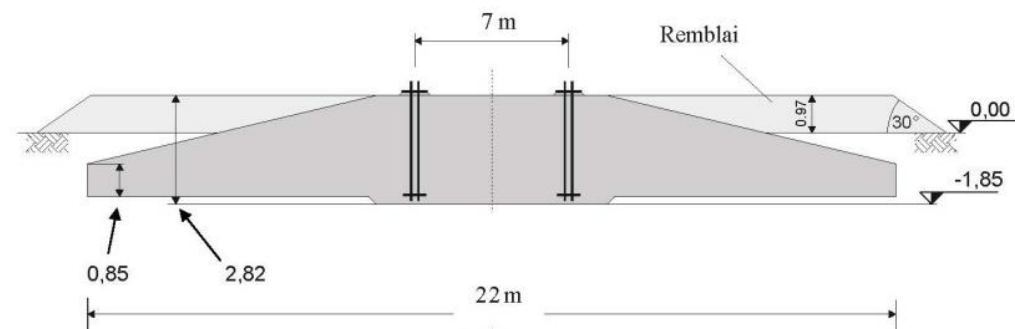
Vue en coupe des fondations (source : Nordex, 2012)
